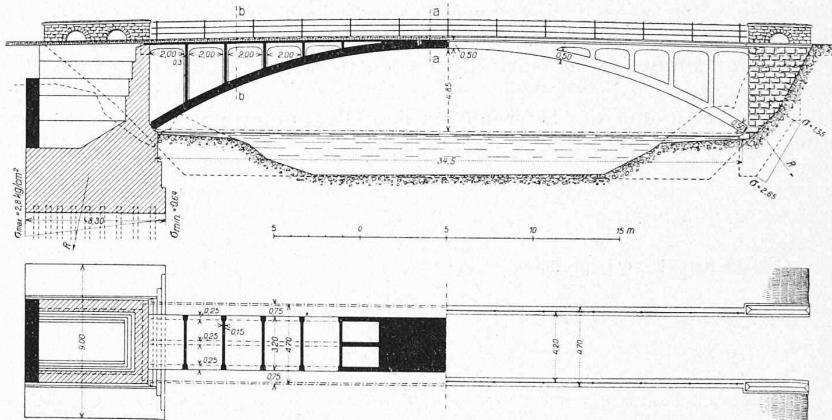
Längsschnitt und Ansicht, Horizontalschnitt und Draufsicht der Glennerbrücke. — Masstab 1:400.
